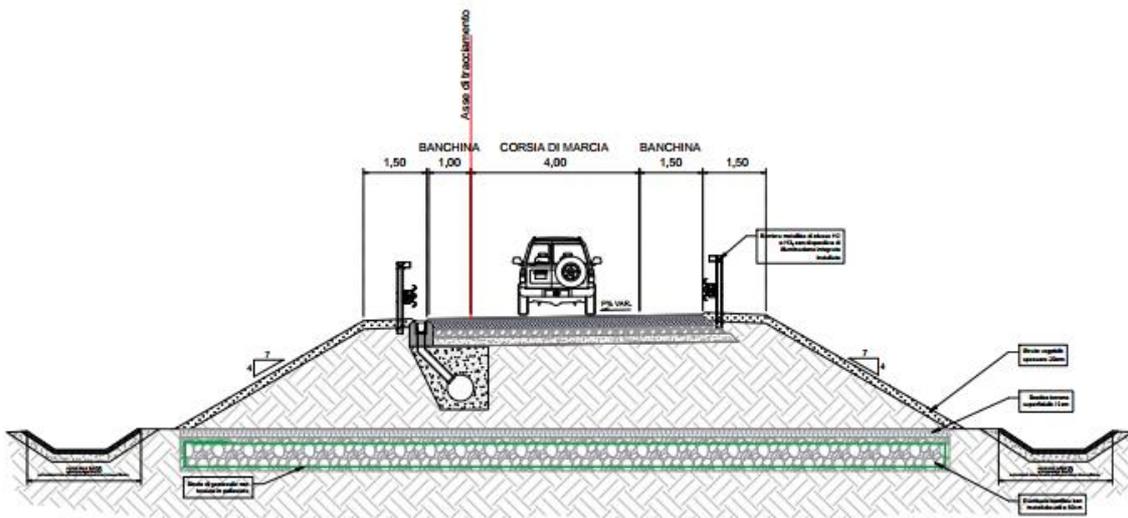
Sezione Tipo in rilevato per il ramo 2
